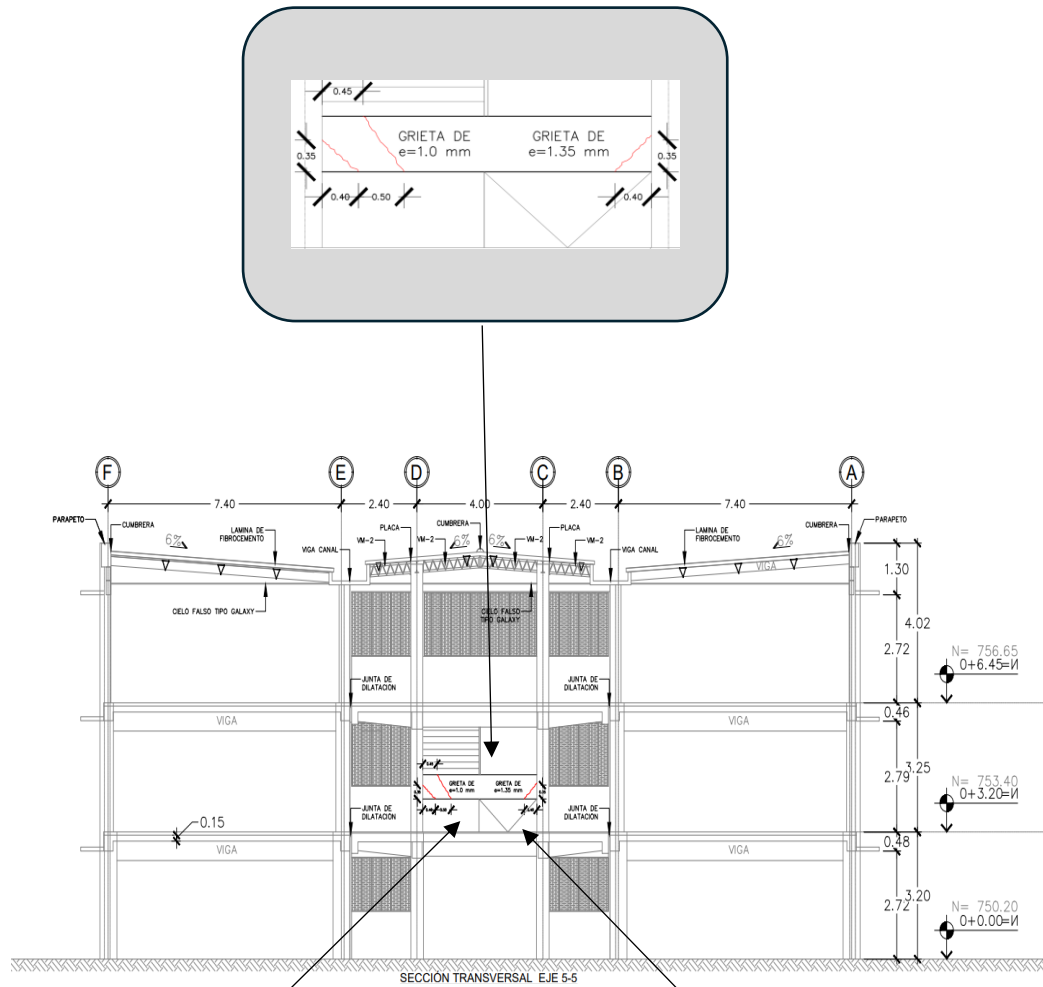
Esquema de daños en viga de descanso de escaleras, segundo nivel.
